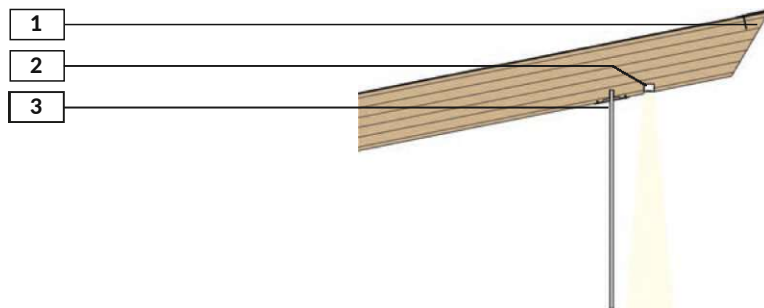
Detail 2: Dachabschluss, eigene Darstellung
